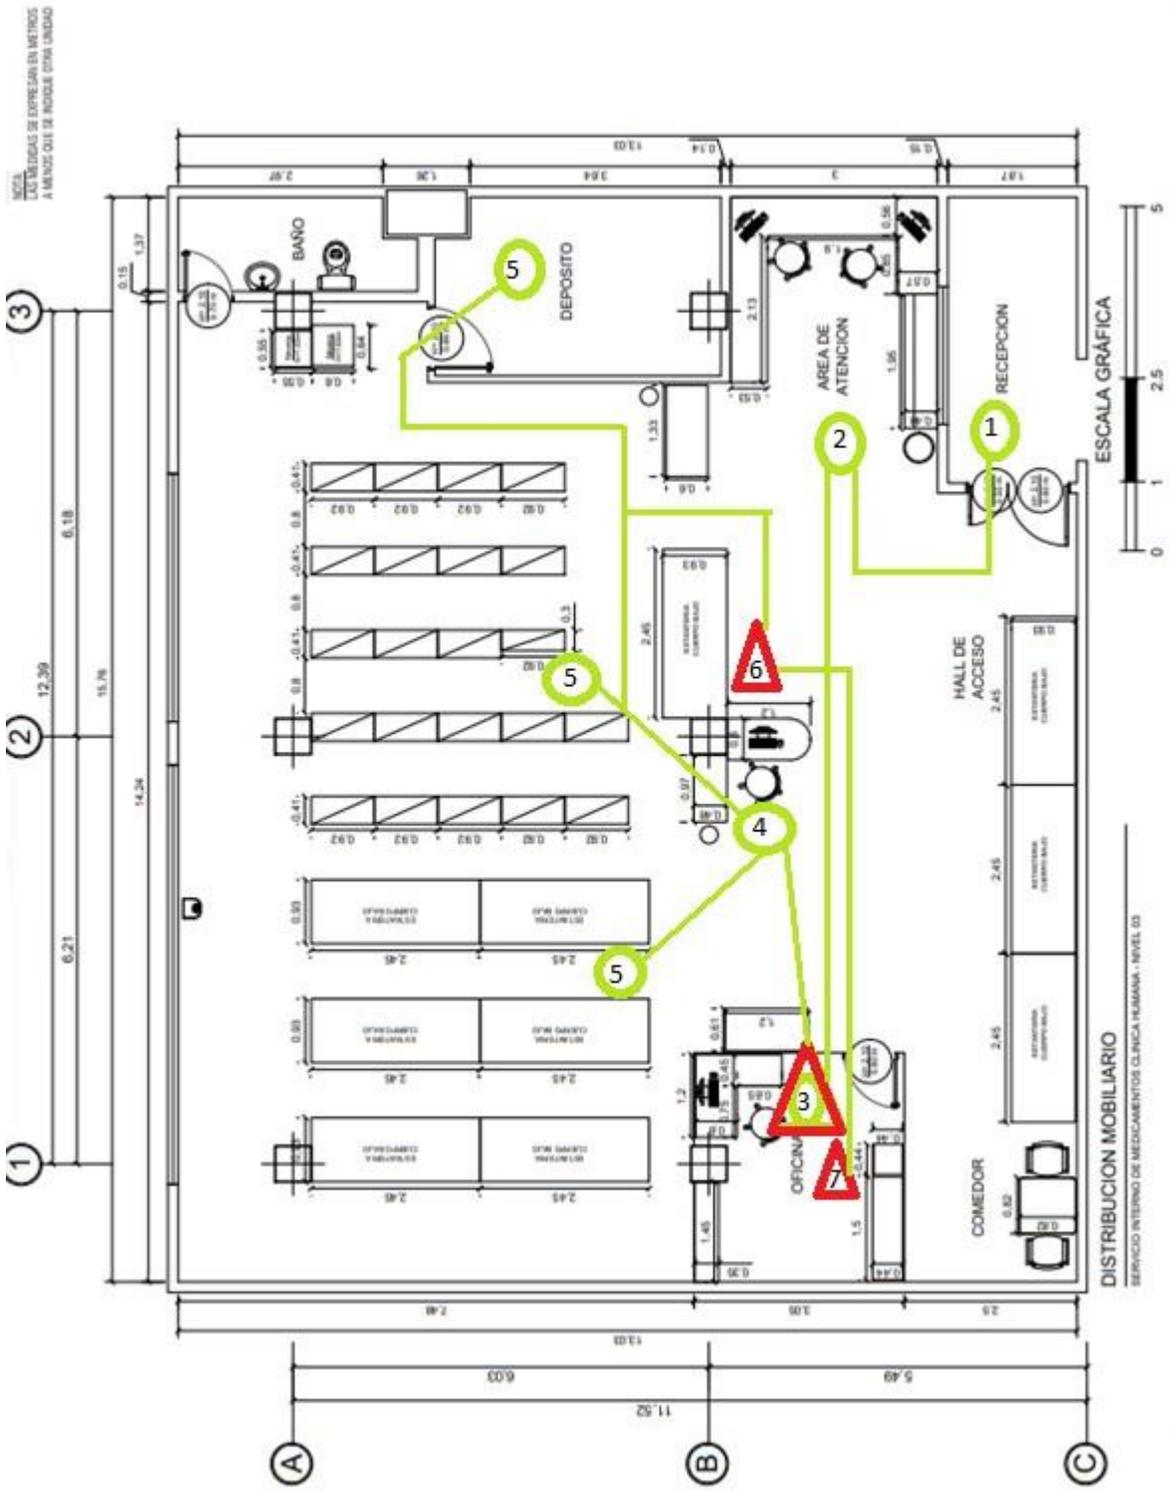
Layout de Almacén de S.I.M. (Elaboración propia, 2022)
